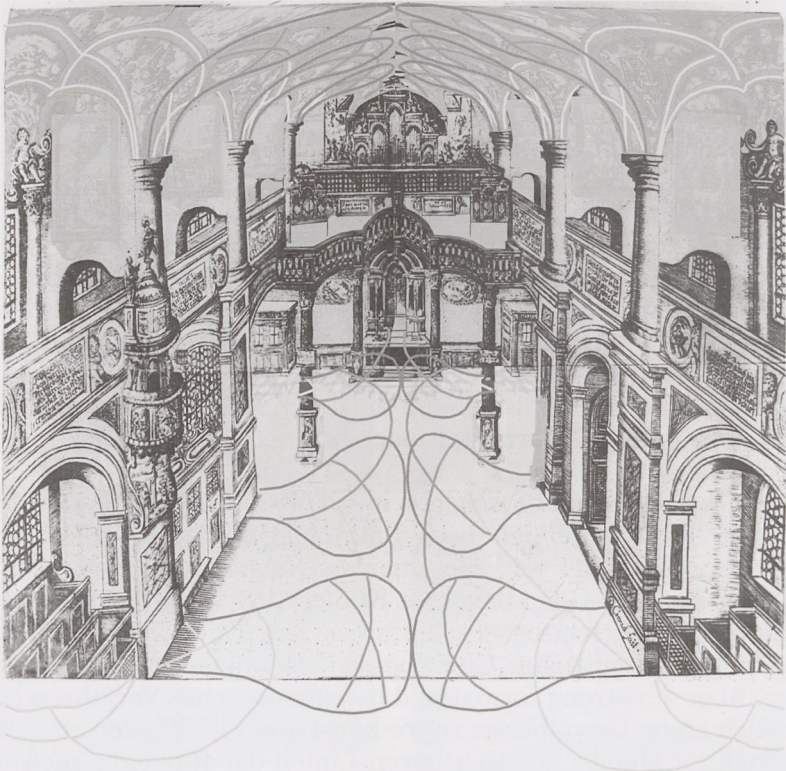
+b: Schlosskapelle Dresden, Übertragung des Rippenwerks in den Grundriss, Architekturbüro Anwand, 2009
